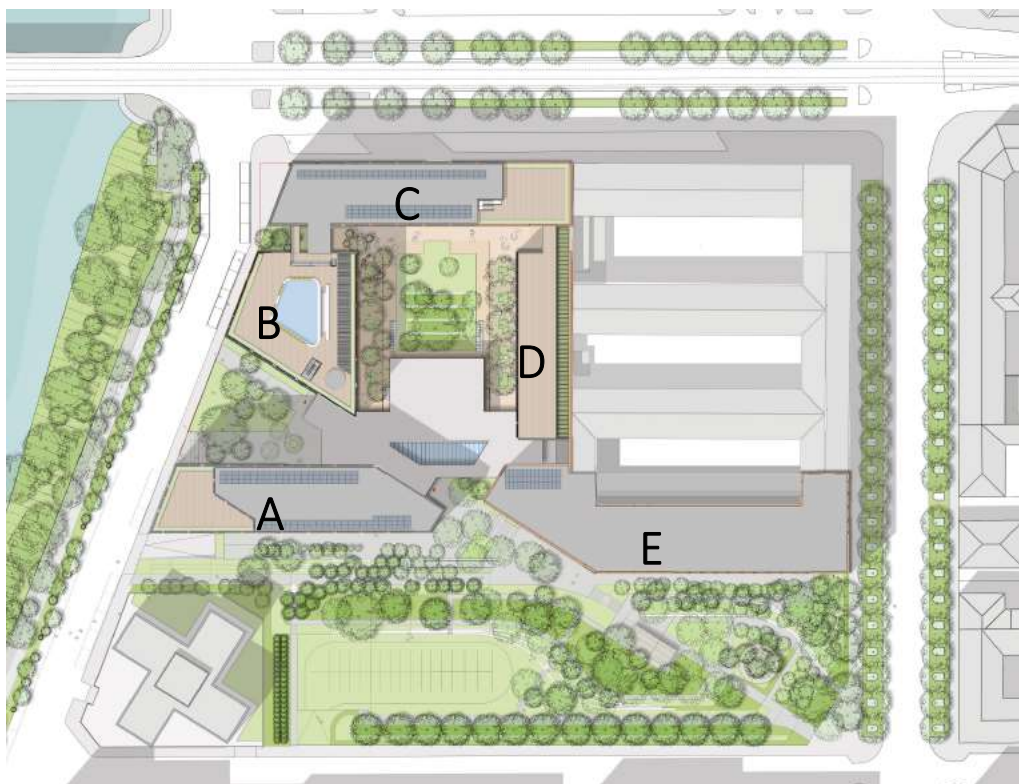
Planimetria Generale della proposta progettuale analizzata
